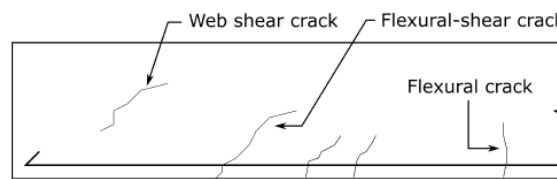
Diferentes tipos de fisuras que desarrolla la viga de hormigón
